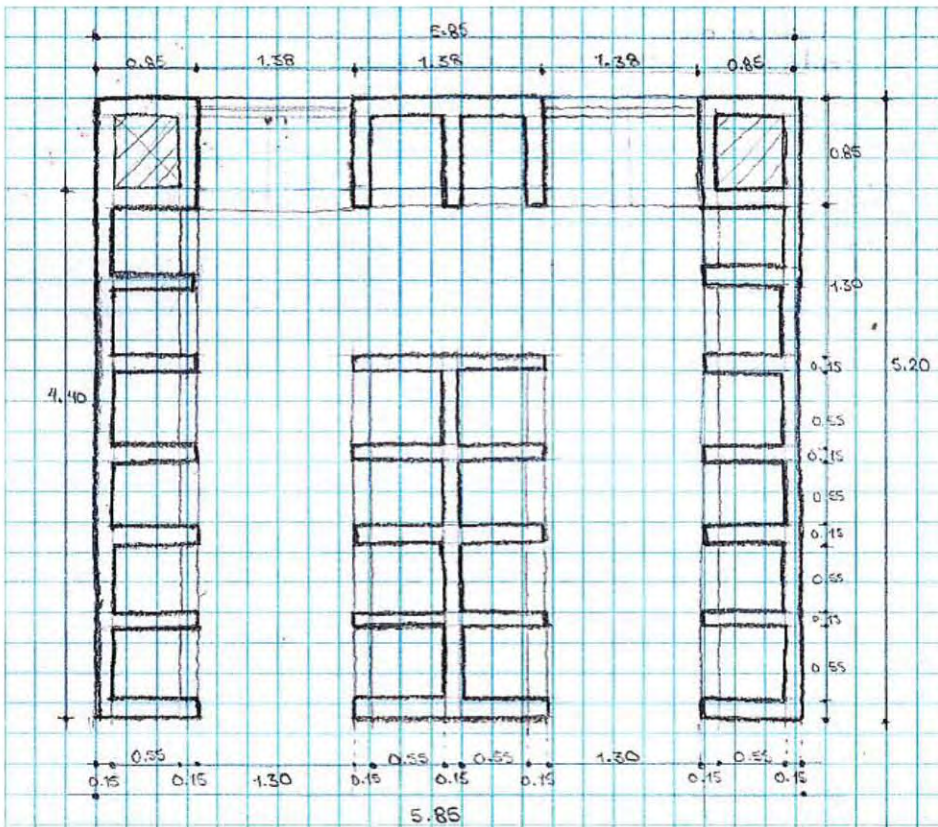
Nichos con dimensiones en planta (dibujo propio)
